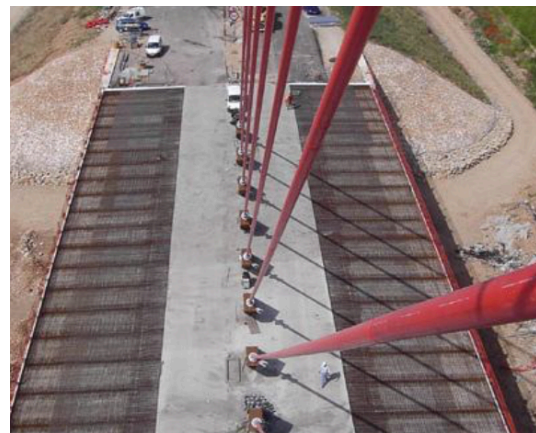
Procés constructiu del Pont d'Arriaca.
